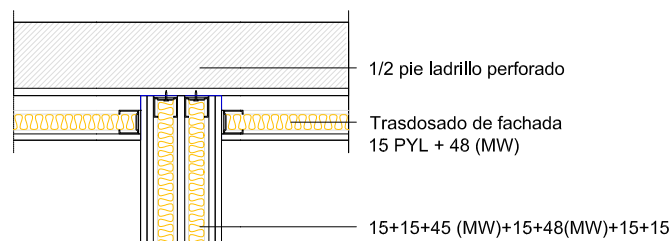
Detalle en planta de la unión elemento de separación vertical con la fachada
